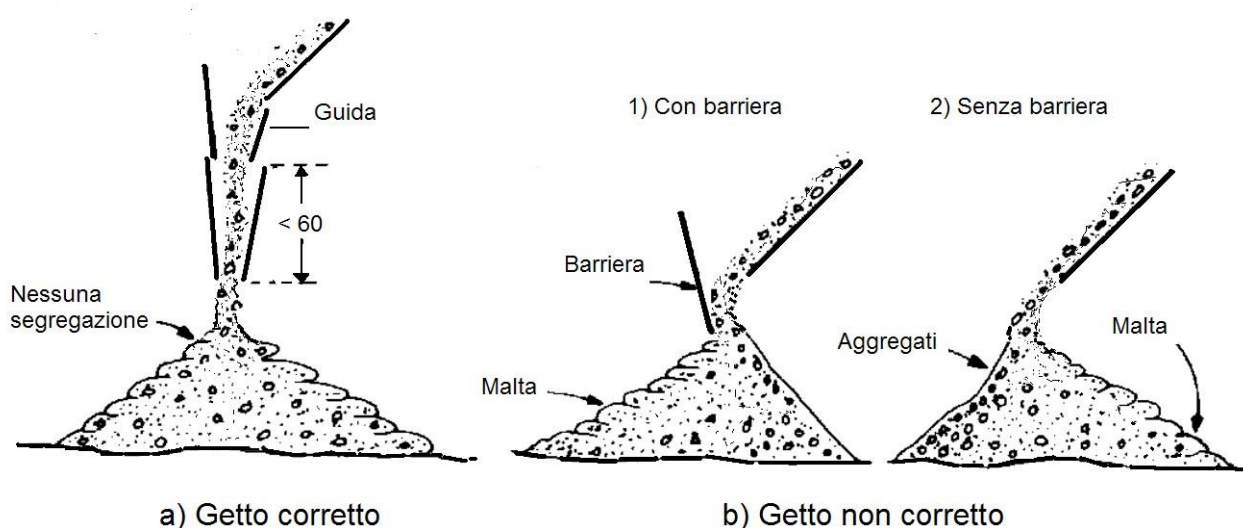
Esempi di getto di calcestruzzo da piano inclinato: a) getto corretto e b) getto non corretto. Nel caso b) si ha la separazione degli aggregati dalla malta cementizia. La barriera comporta soltanto il cambiamento di direzione della segregazione.
